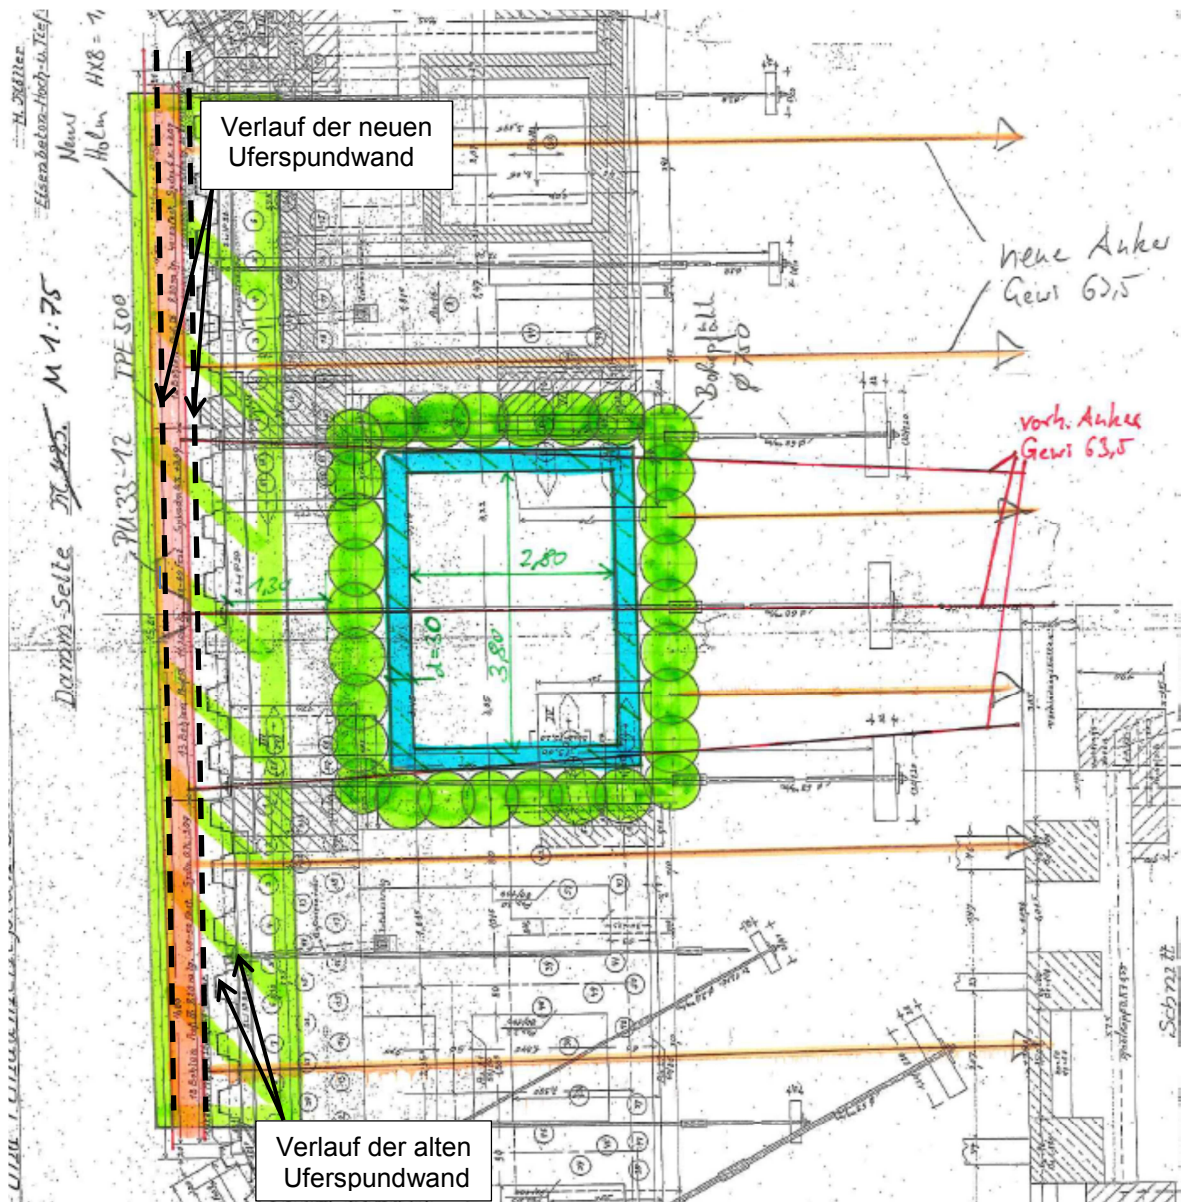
Widerlagerbank mit Spundwandverankerung und Maschinenkeller, Grundriss
